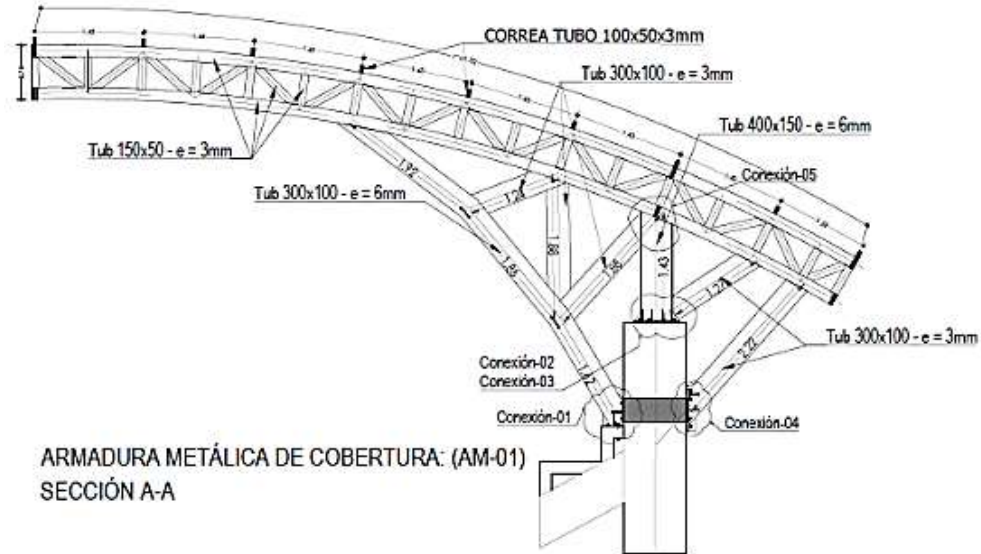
La imagen muestra el plano detallado de la armadura metálica AM-01, un componente fundamental de un pórtico metálico. El plano incluye las dimensiones, materiales y detalles de las uniones de la armadura, lo que permite visualizar con precisión la estructura y los puntos donde se realizaron las mediciones para evaluar la precisión del ensamblaje.
